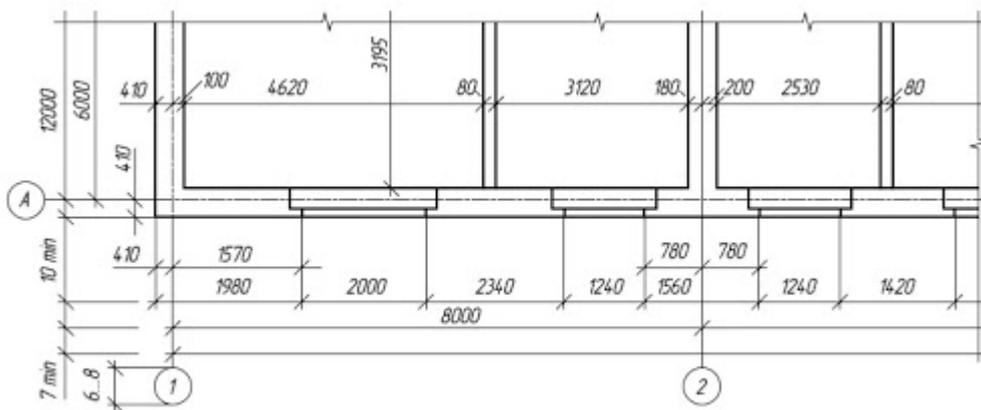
Нанесение размерных линий на фрагменте плана здания
